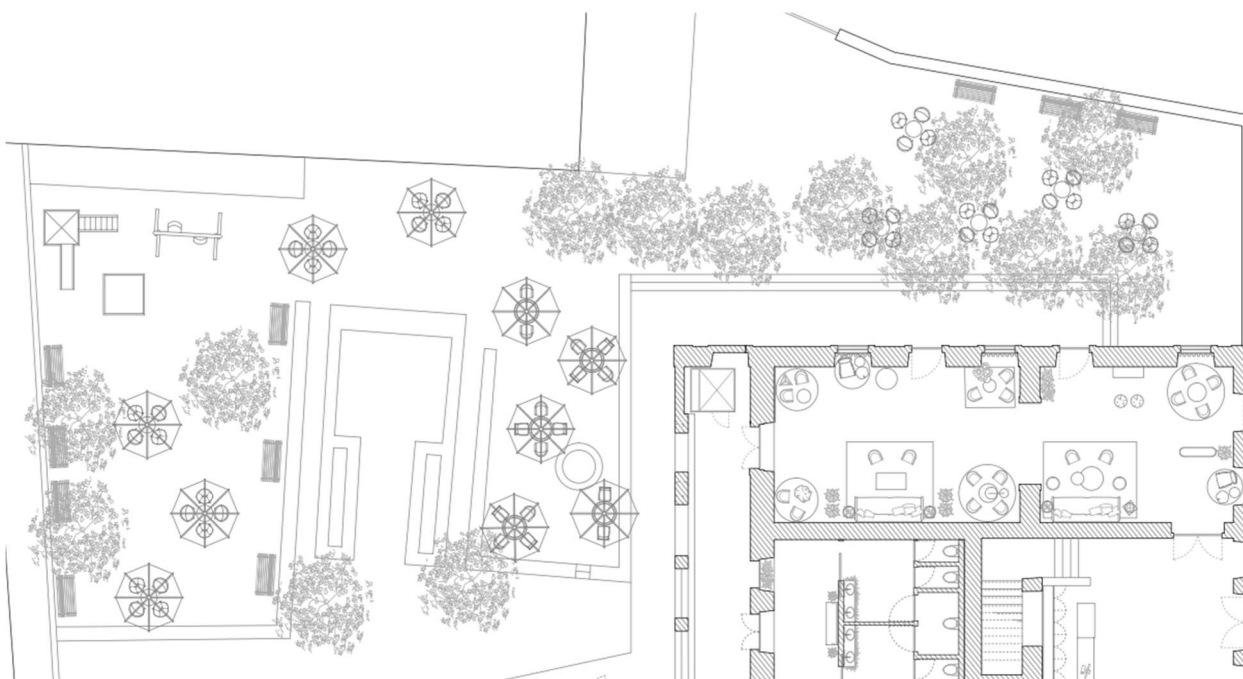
Excerto da Planta do Piso 0 - Fonte: Bruna Monteiro
